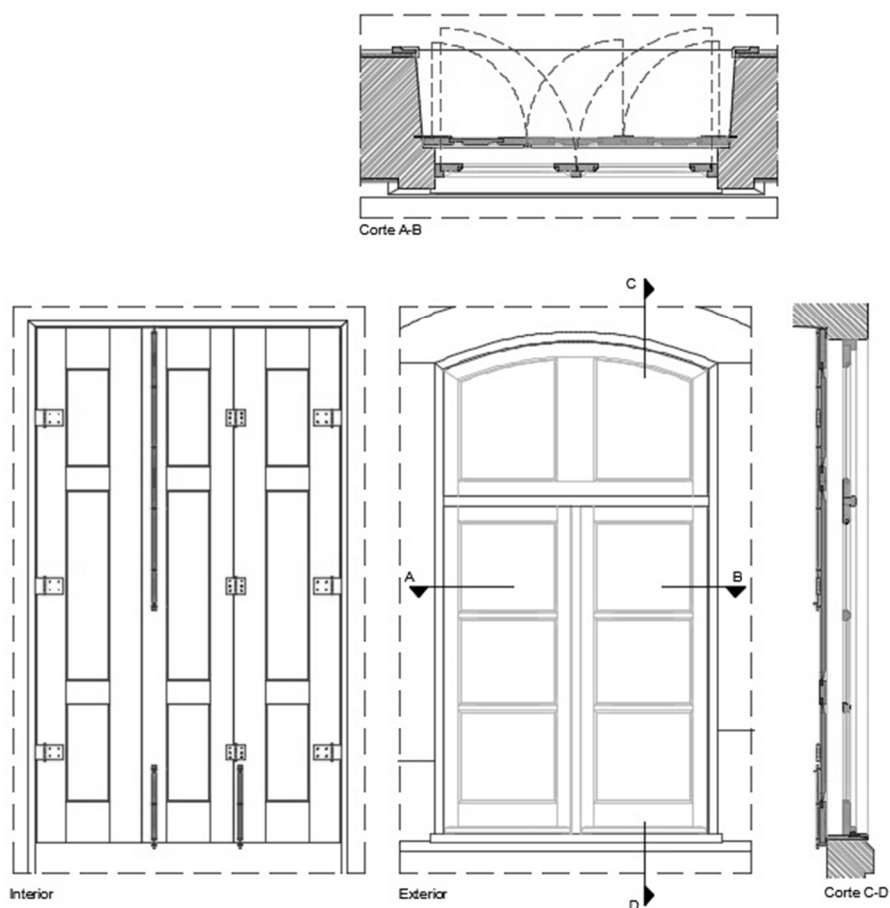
Pormenor de Caixilharia exterior (s/escala) – (Autor)
